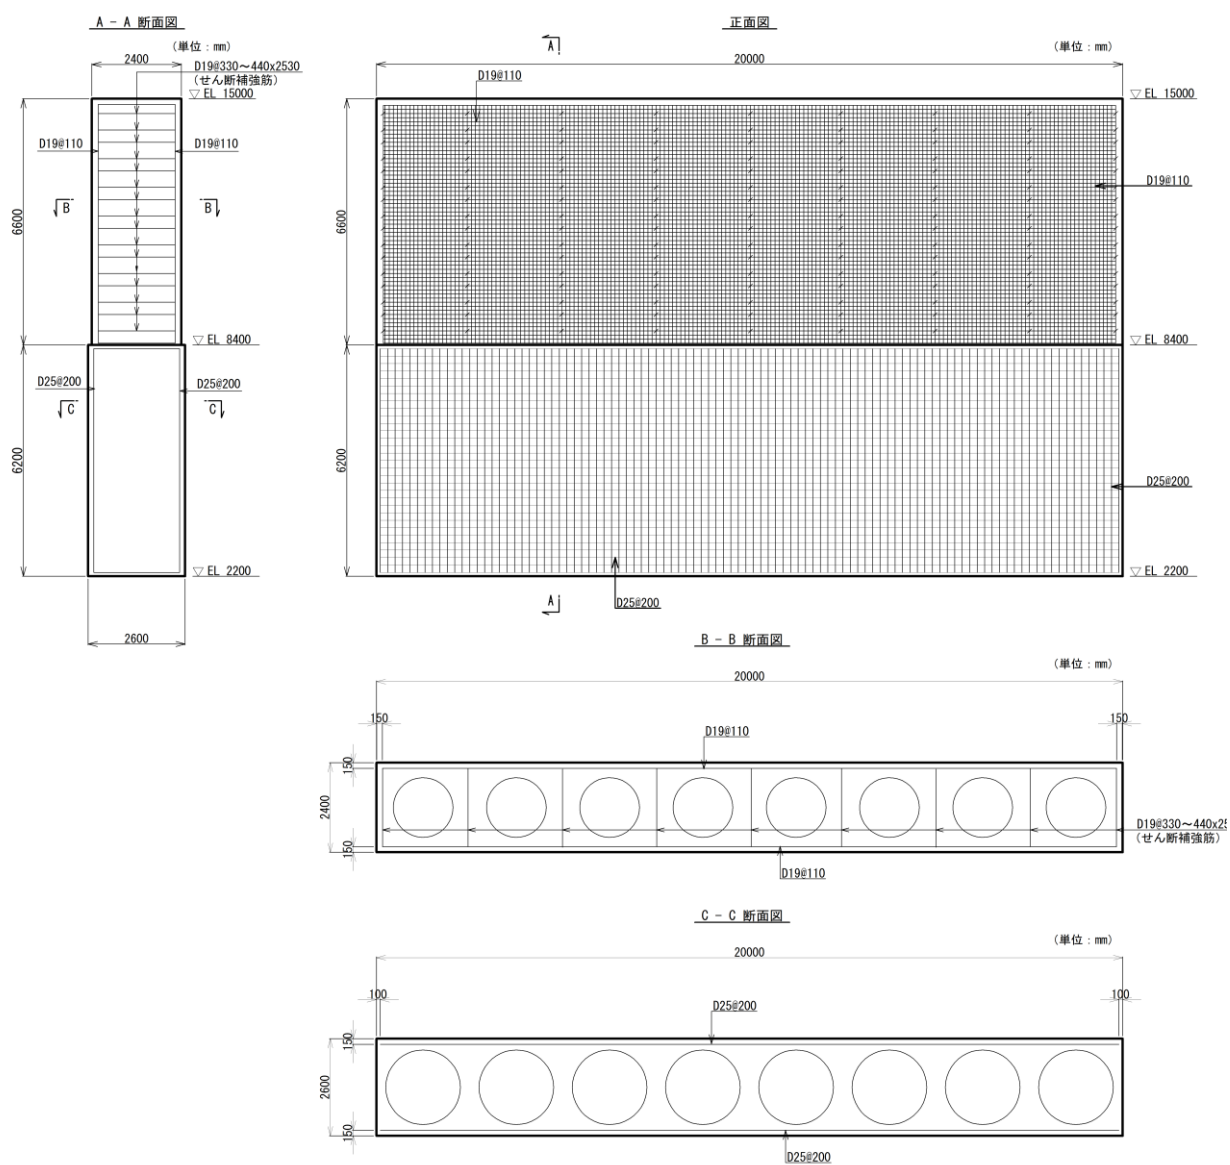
防波壁 (多重鋼管杭式擁壁) の被覆コンクリート壁の概略配筋図 (③-③断面)
